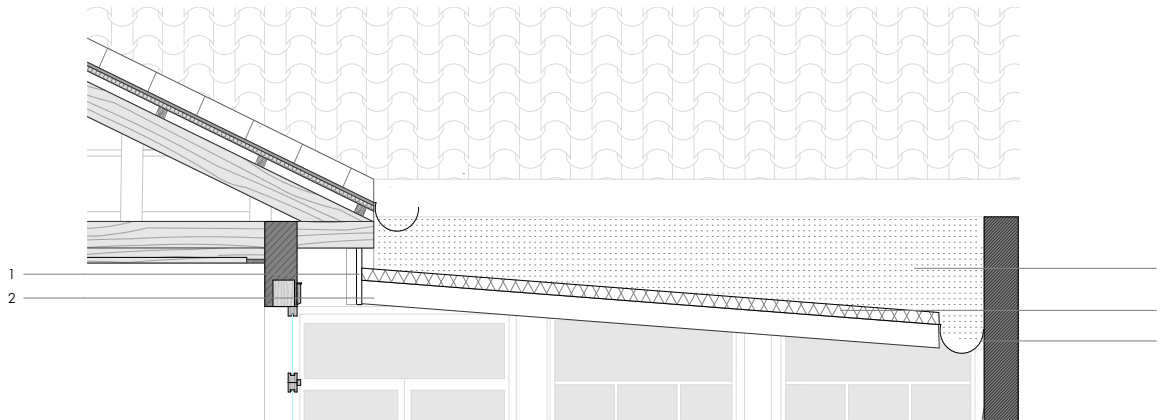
Detalle constructivo 22 | Estado Actual, cubierta segundo patio.
